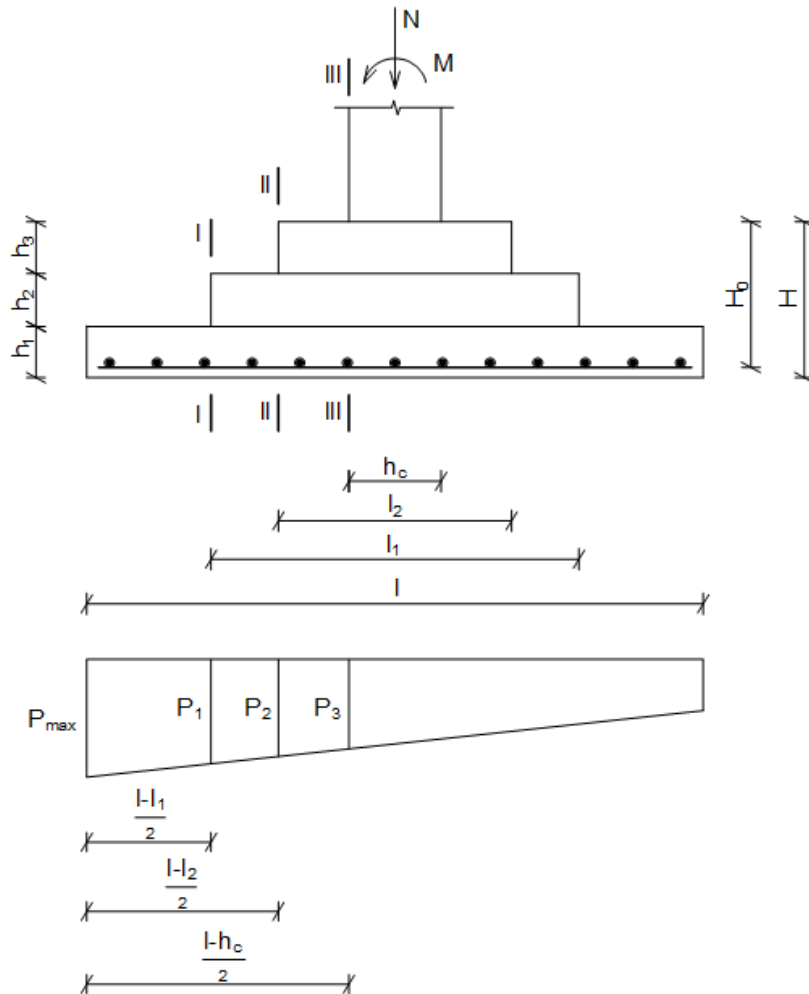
До визначення площі арматури подошви фундаменту
